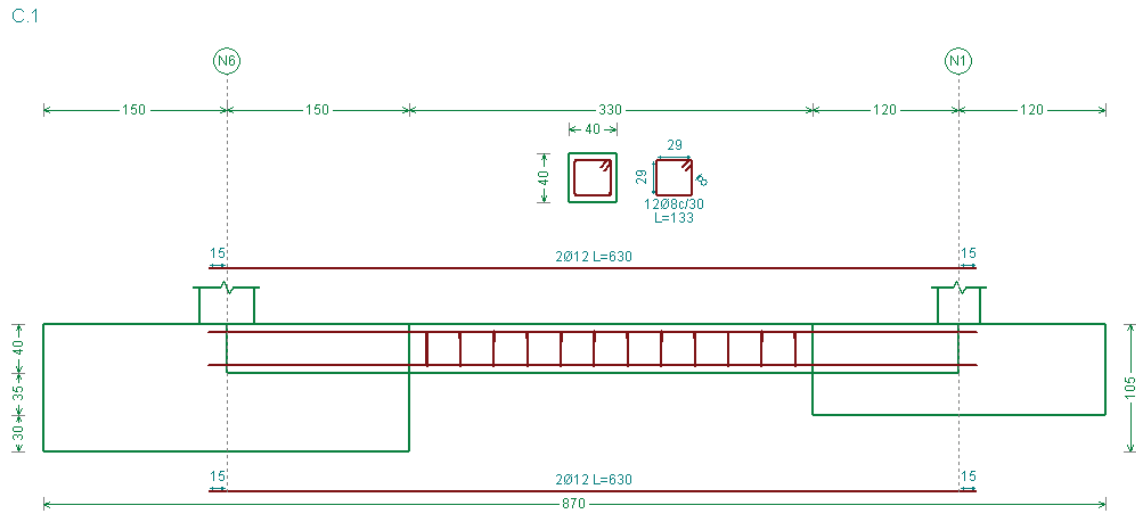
Armado viga riostra zapata tipo-zapata hastial
